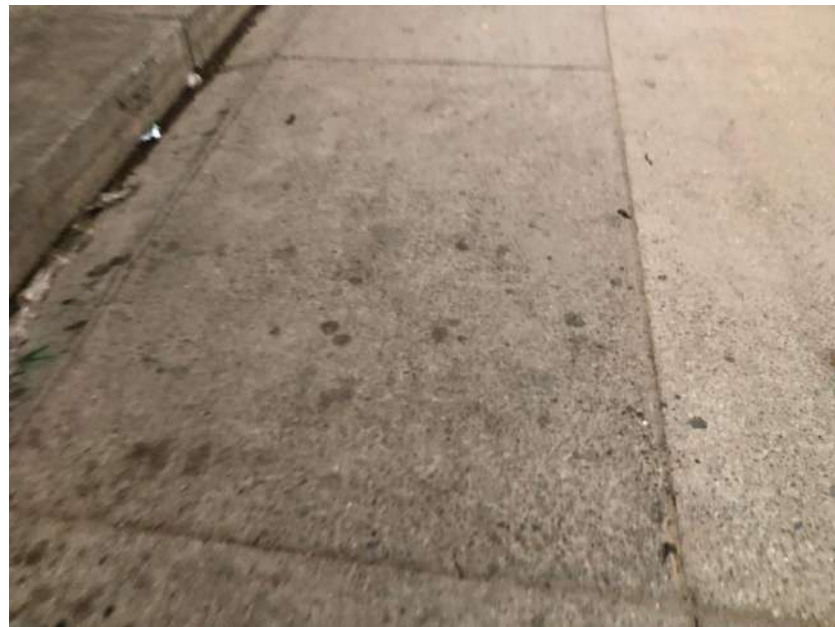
Tramo 14 UM – 42 Popouts con grietas lineales
